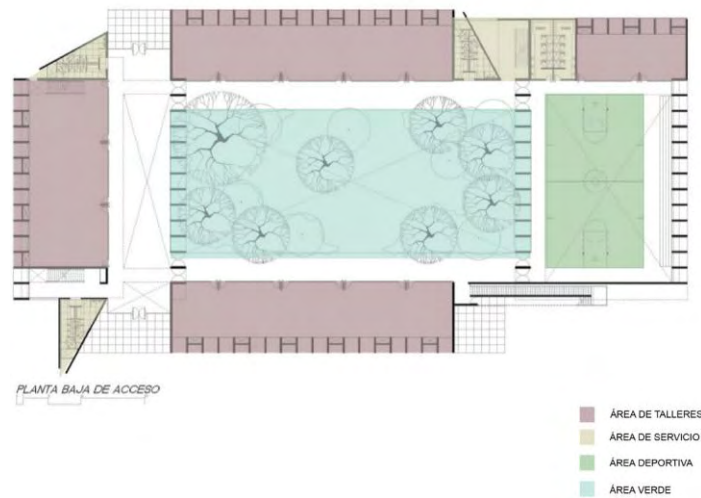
Centro Comunitario Independencia, análisis de la planta. Elaboración propia con planta de Landa Arquitectos. Disponible en: <https://www.archdaily.mx/mx/02-120997/centro-comunitario-independencia-agustin-landa-catedra-blanca-workshopA>
